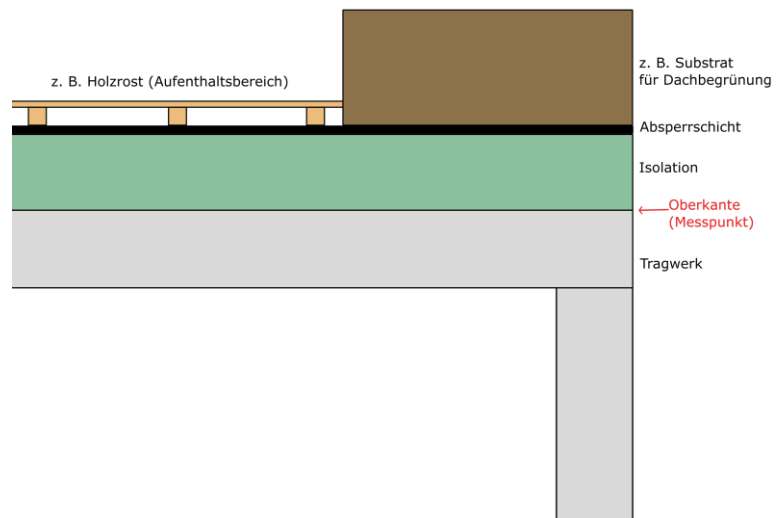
Schema des Dachaufbaus und Verortung Messpunkt Oberkante
